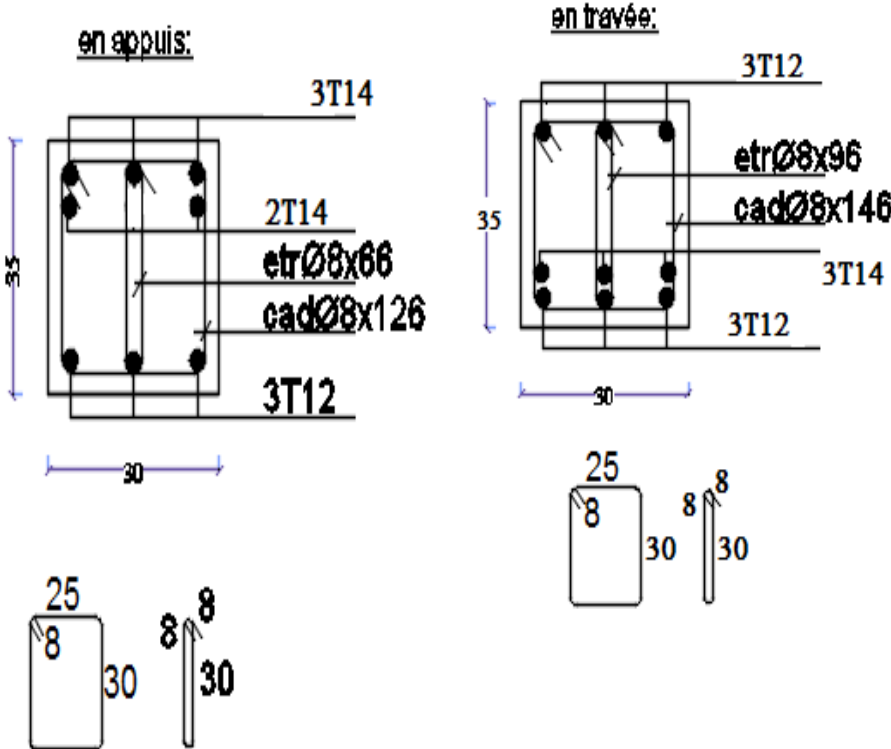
Schéma de ferrailage des poutres secondaires
